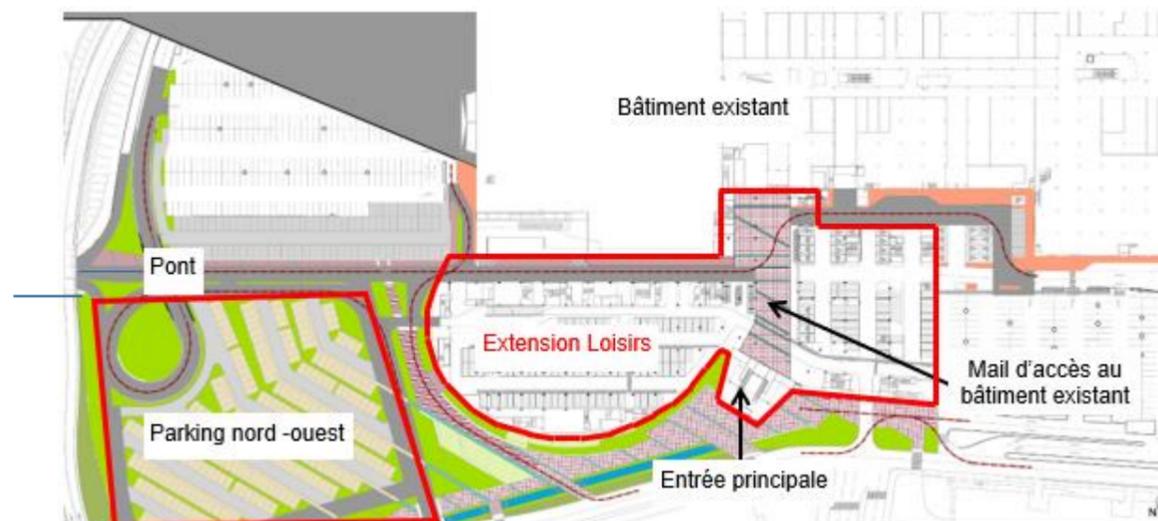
Plan masse de l'extension Loisirs (sans échelle)
